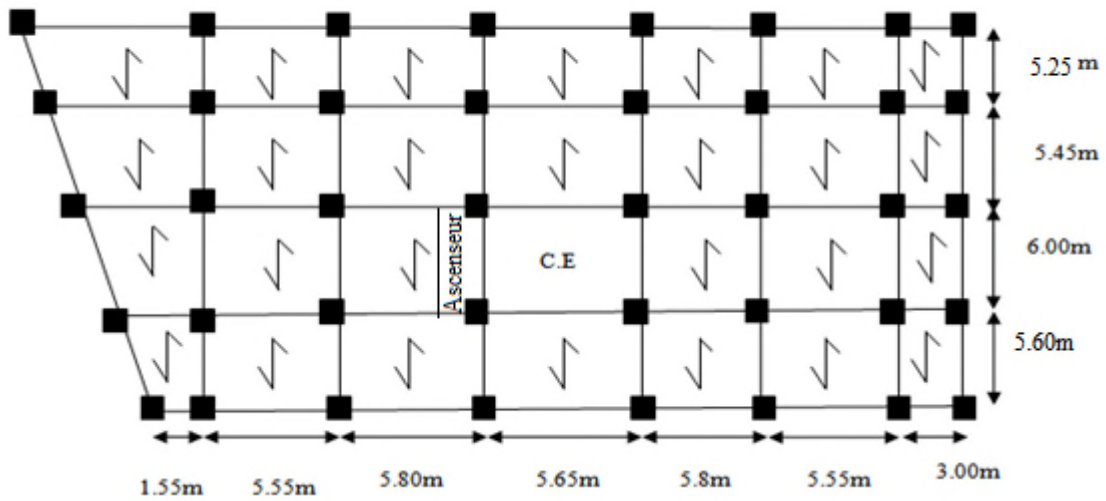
Disposition des Poutrelle 1^{er} et 2^{ème} étage
